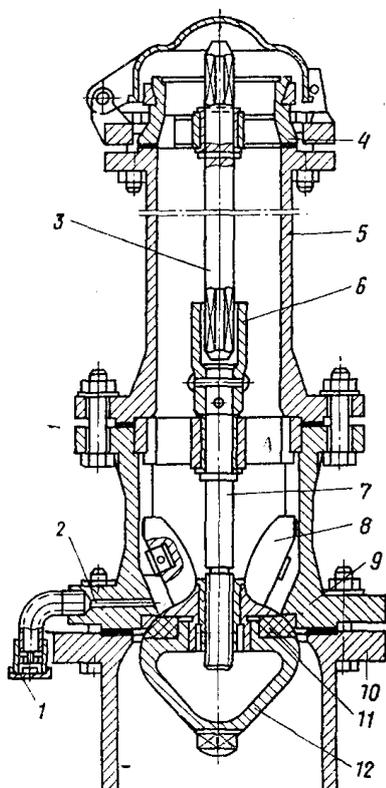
Пожарный подземный гидрант: 1 – сливная трубка; 2 – спускное отверстие; 3 – штанга; 4 – установочная головка; 5 – стояк; 6 – муфта; 7 – шпindel; 8 – фиксаторы; 9 – клапанная коробка; 10 – тройник водопроводной сети; 11 – уплотняющее резиновое кольцо; 12 – клапан
